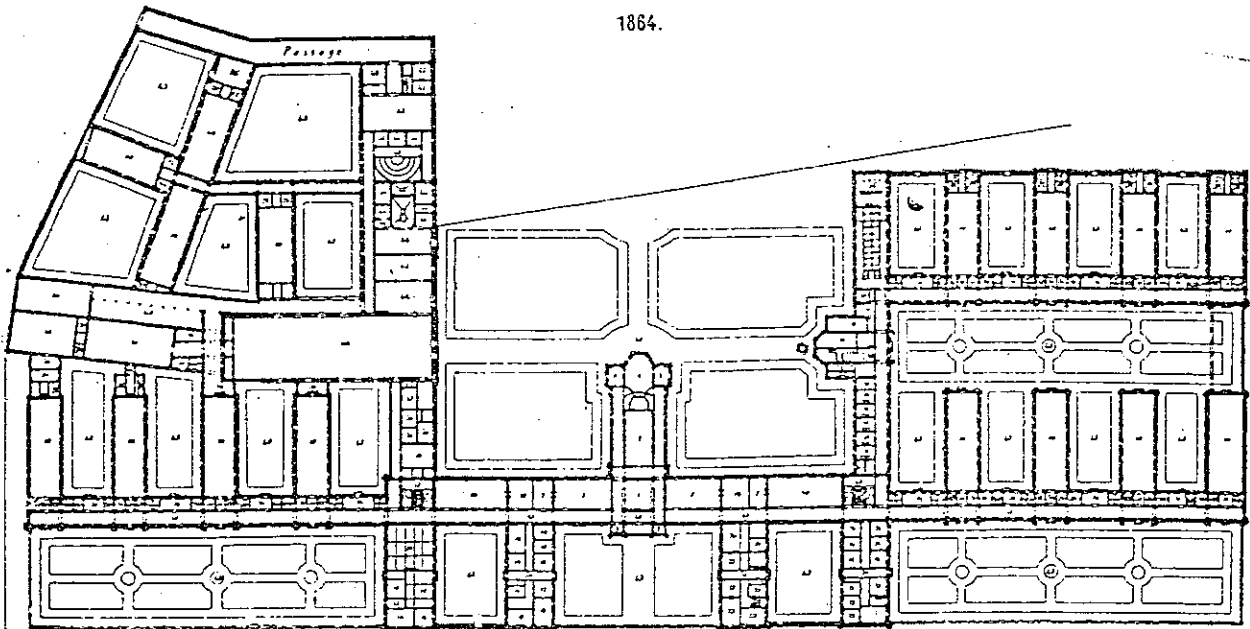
Plan du rez-de-chaussée. — Échelle 0,0005 p. 1 mètre.
